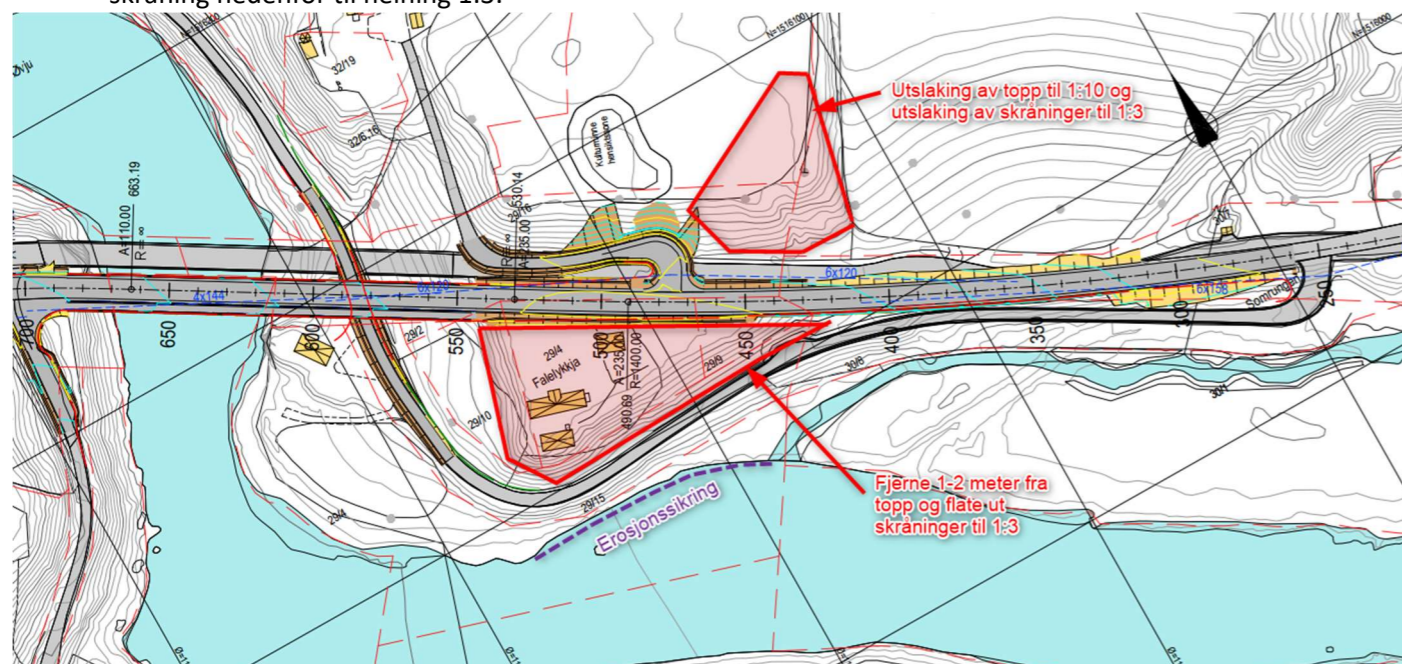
Planlagt erosjonssikring nedenfor Falelykkja, utklipp plan, EFLA AS
